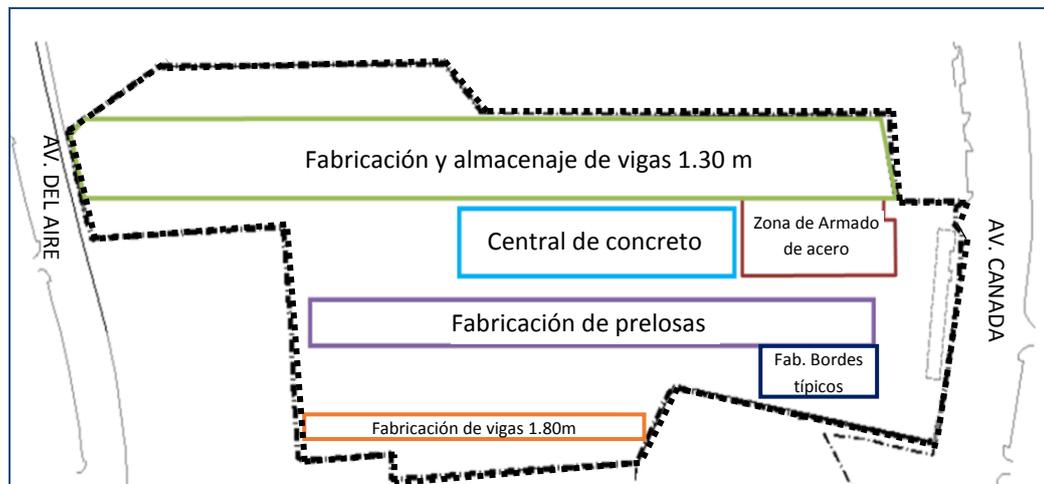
Layout Planta de Prefabricados Tramo 1 –Línea 1.
